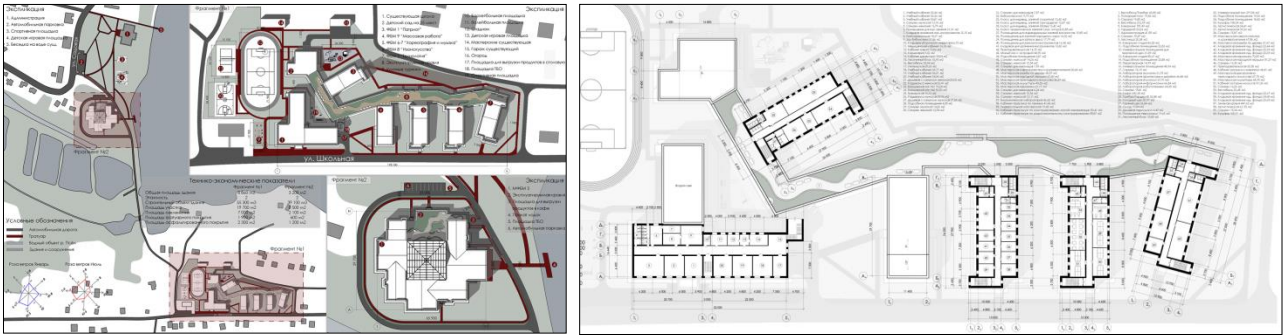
С. Береговое. Генеральный план образовательного комплекса полного дня; план 2 этажа с «зеленой» крышей – зона отдыха над многофункциональной рекреацией
